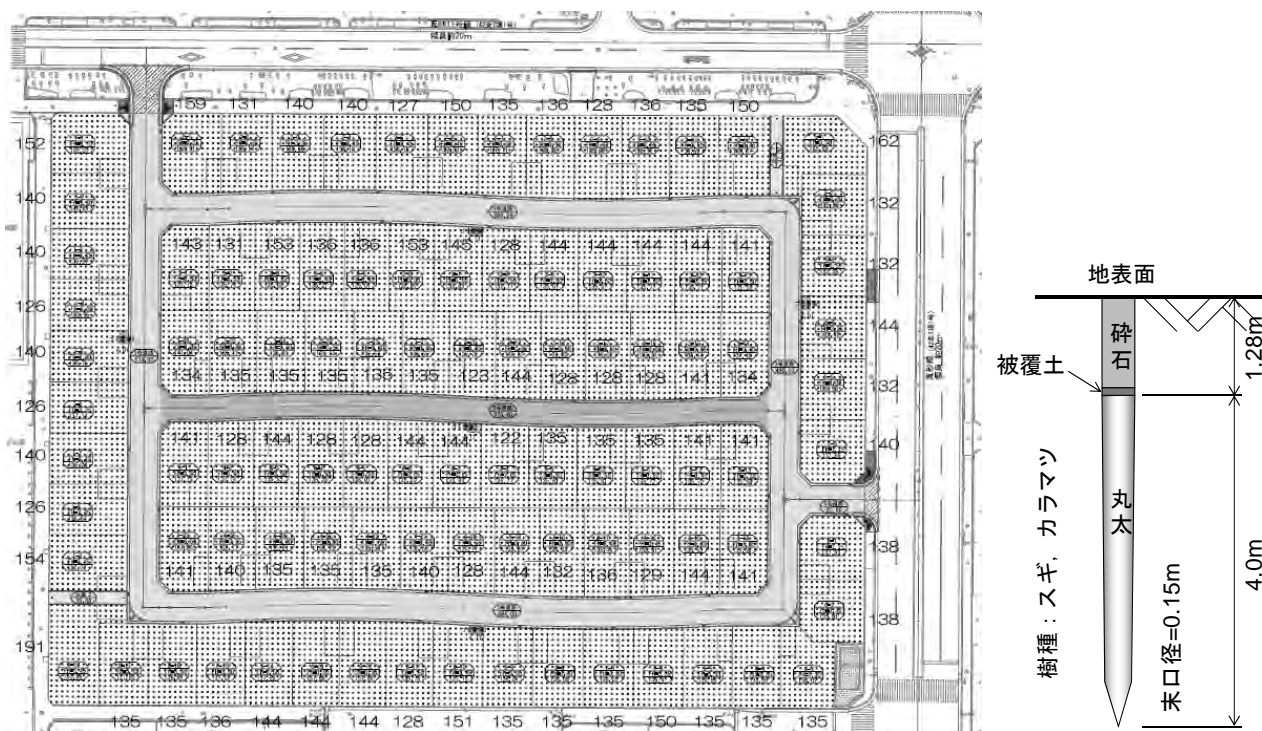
丸太伏せ図と断面図 (丸太打設間隔 1.0m)
